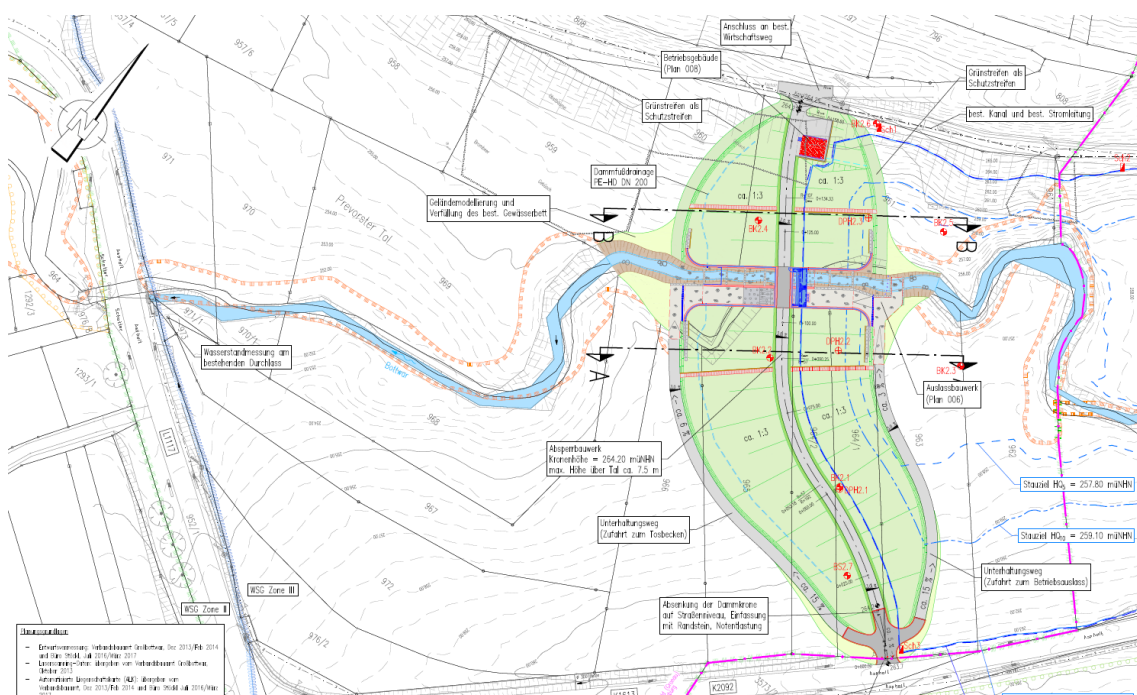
Unmaßstäblicher Lageplan des Dammbauwerkes mit Wasserstandsmessung an bestehendem Durchlass der L 1117 (Detaillierter Darstellung siehe Unterlagen Teil B Plan 004, INGENIEURBÜRO WINKLER UND PARTNER, 2019/2020)
